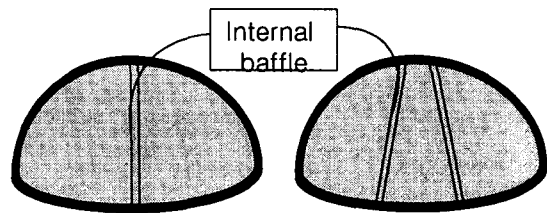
수해 방지를 위해 사용된 Water Wall 사용 사례
